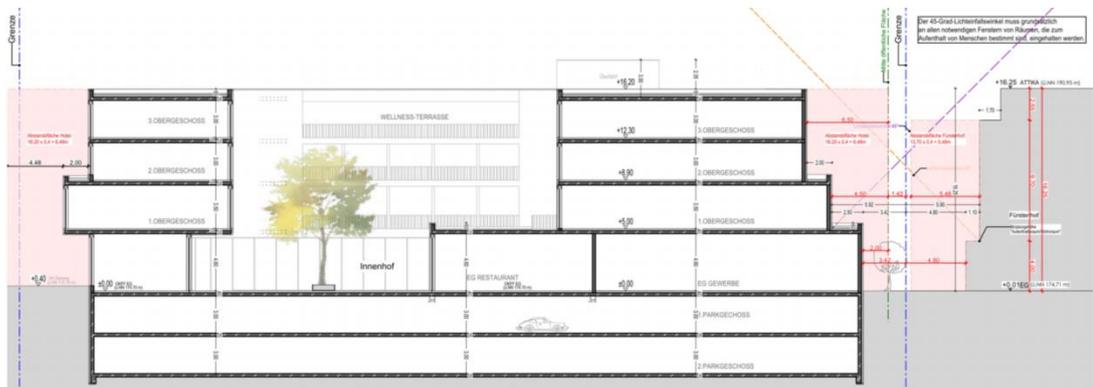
Gebäudeschnitt (Stand Jan. 2021)
